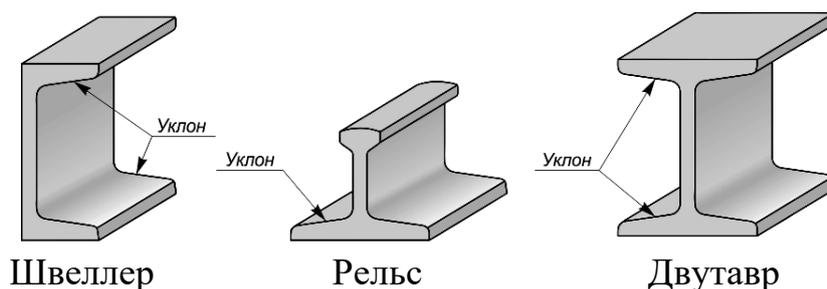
Стальной фасонный прокат для металлоконструкций
